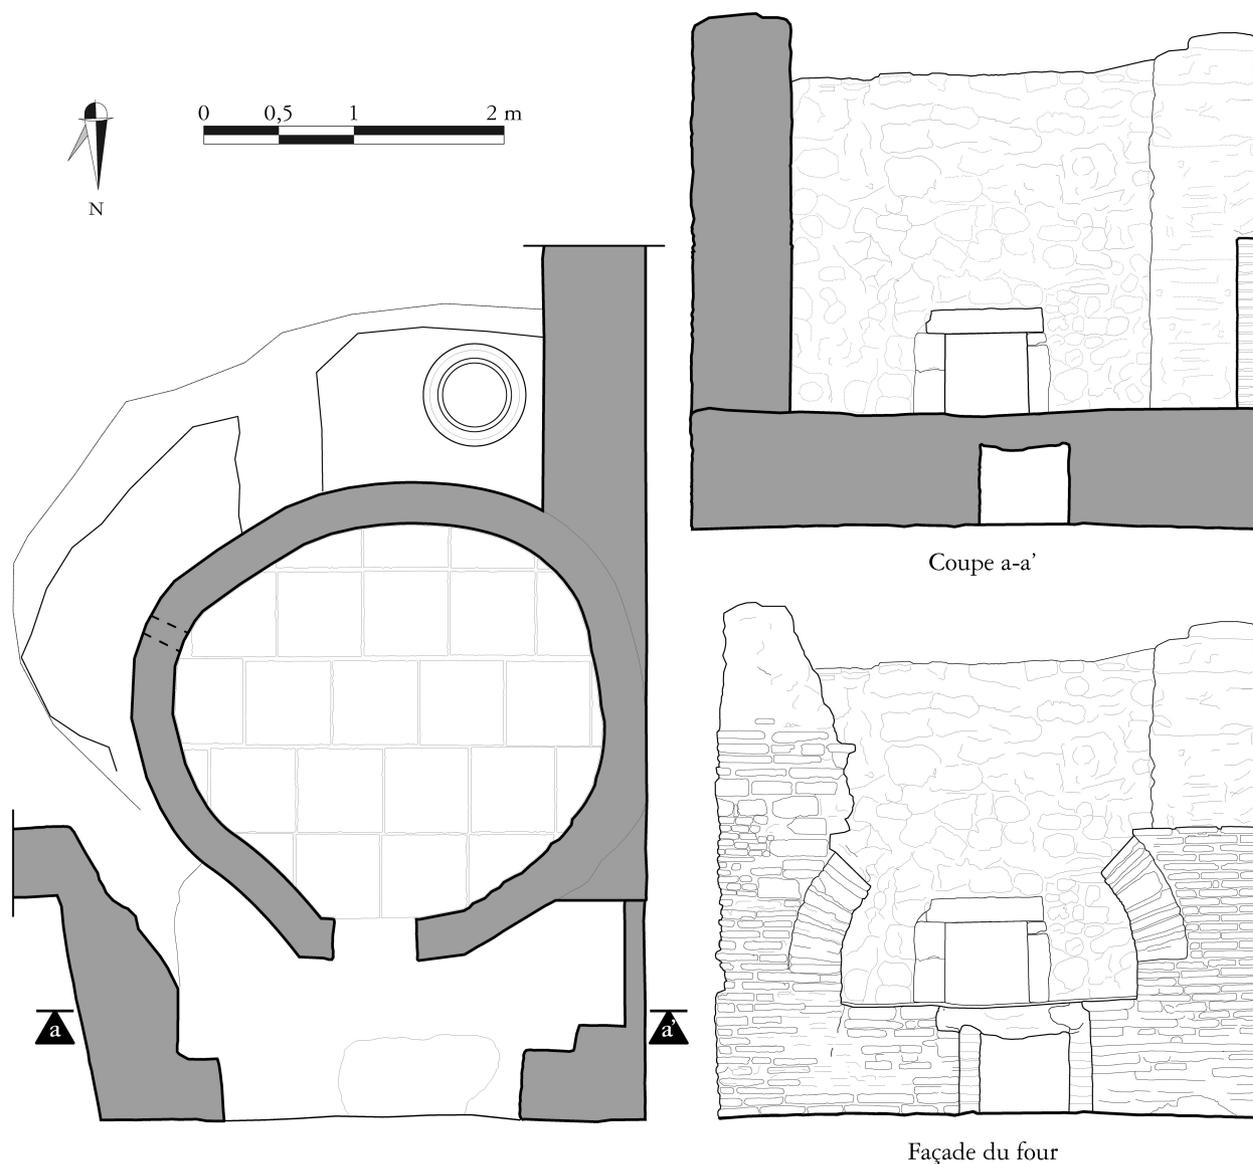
Pompéi Pistrina. Relevé de la façade, coupe sagittale plan du four situé dans la boulangerie V 3, 8 (relevé-dessin : V. Albano; échelle : 1/50).
